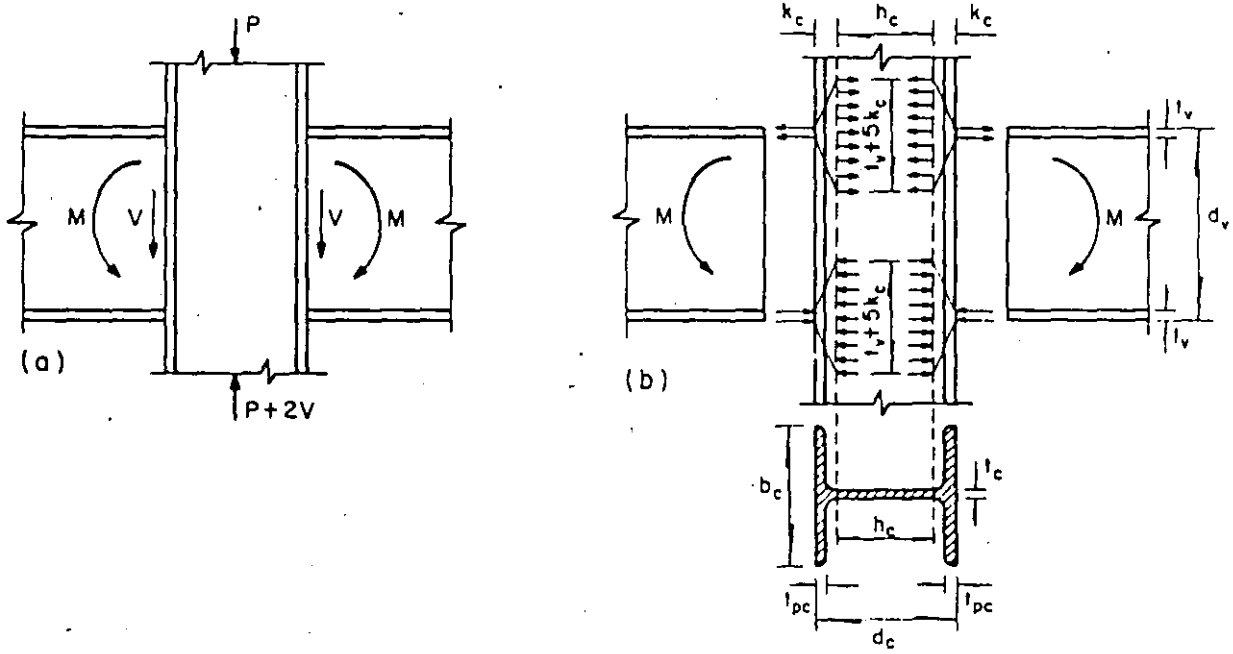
Conexión viga-columna con carga vertical simétrica. Acciones sobre la columna
